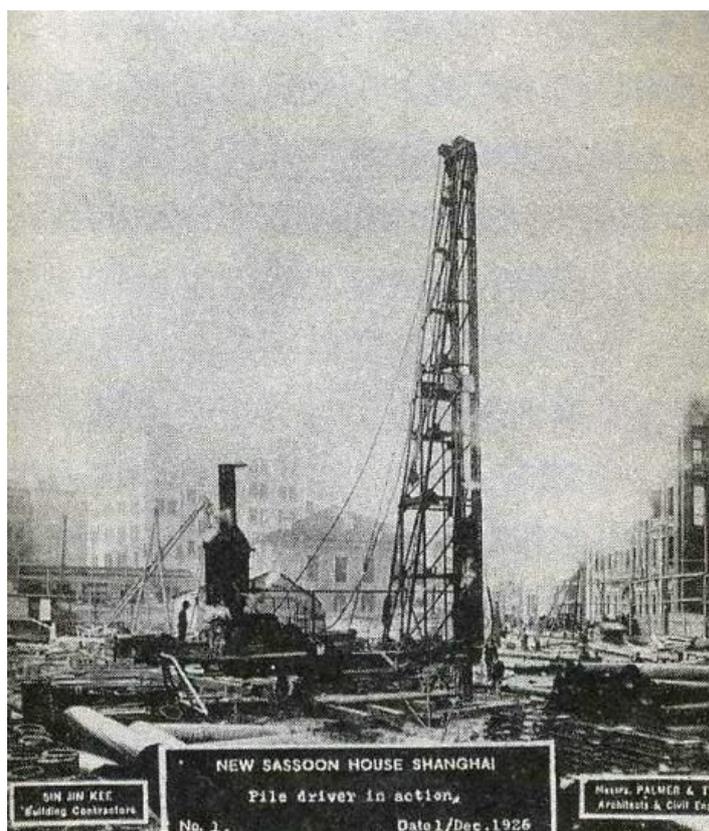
Perforadora de pilotes en la construcción de la “Casa de Sassoon”
